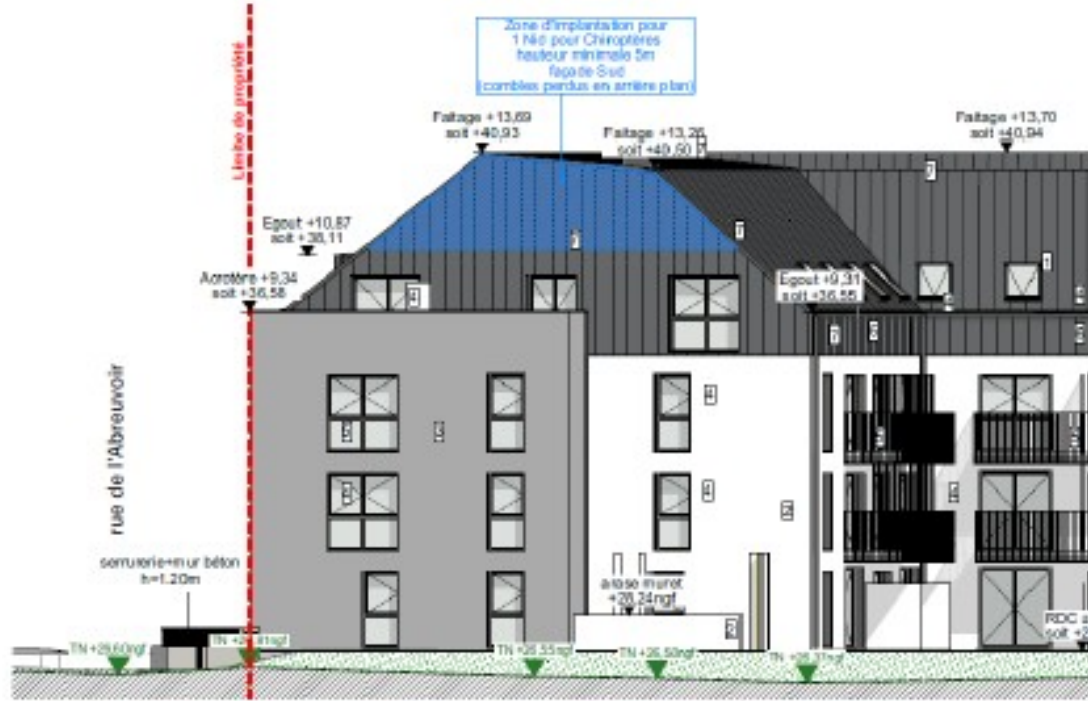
Zoom du plan de façade sud localisant les mesures d'accompagnement - PRISM architectes associées
